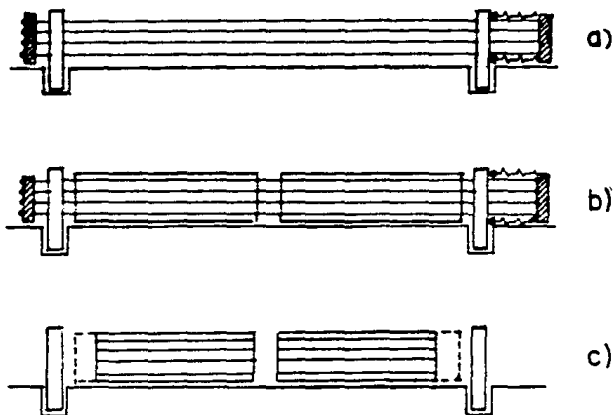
Banco de pretensado: a) Tensado de los alambres; b) Colado de las piezas; c) Aflojamiento del tensado tras el endurecimiento del concreto por corte de los alambres.
